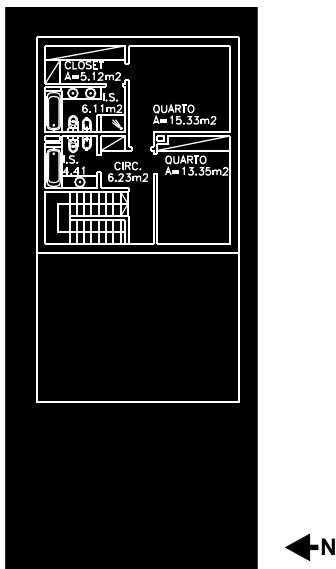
Planta esquemática do piso 1 (moradia T4)
